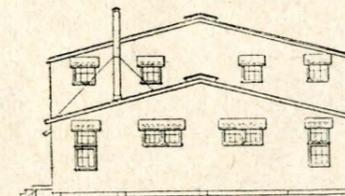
Baraccamento in elevazione, alla estremità occupata dalla cucina e refettorio.
